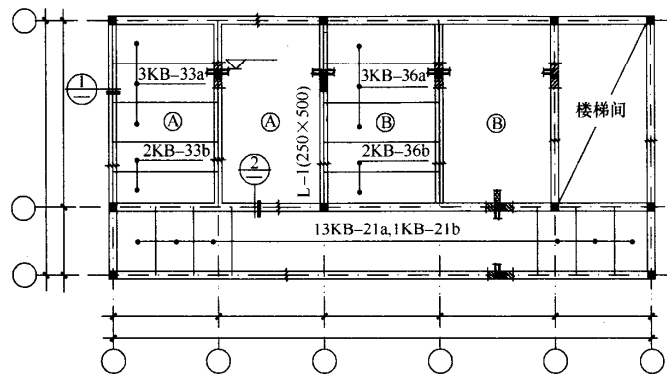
用正投影法绘制预制楼板结构平面图
